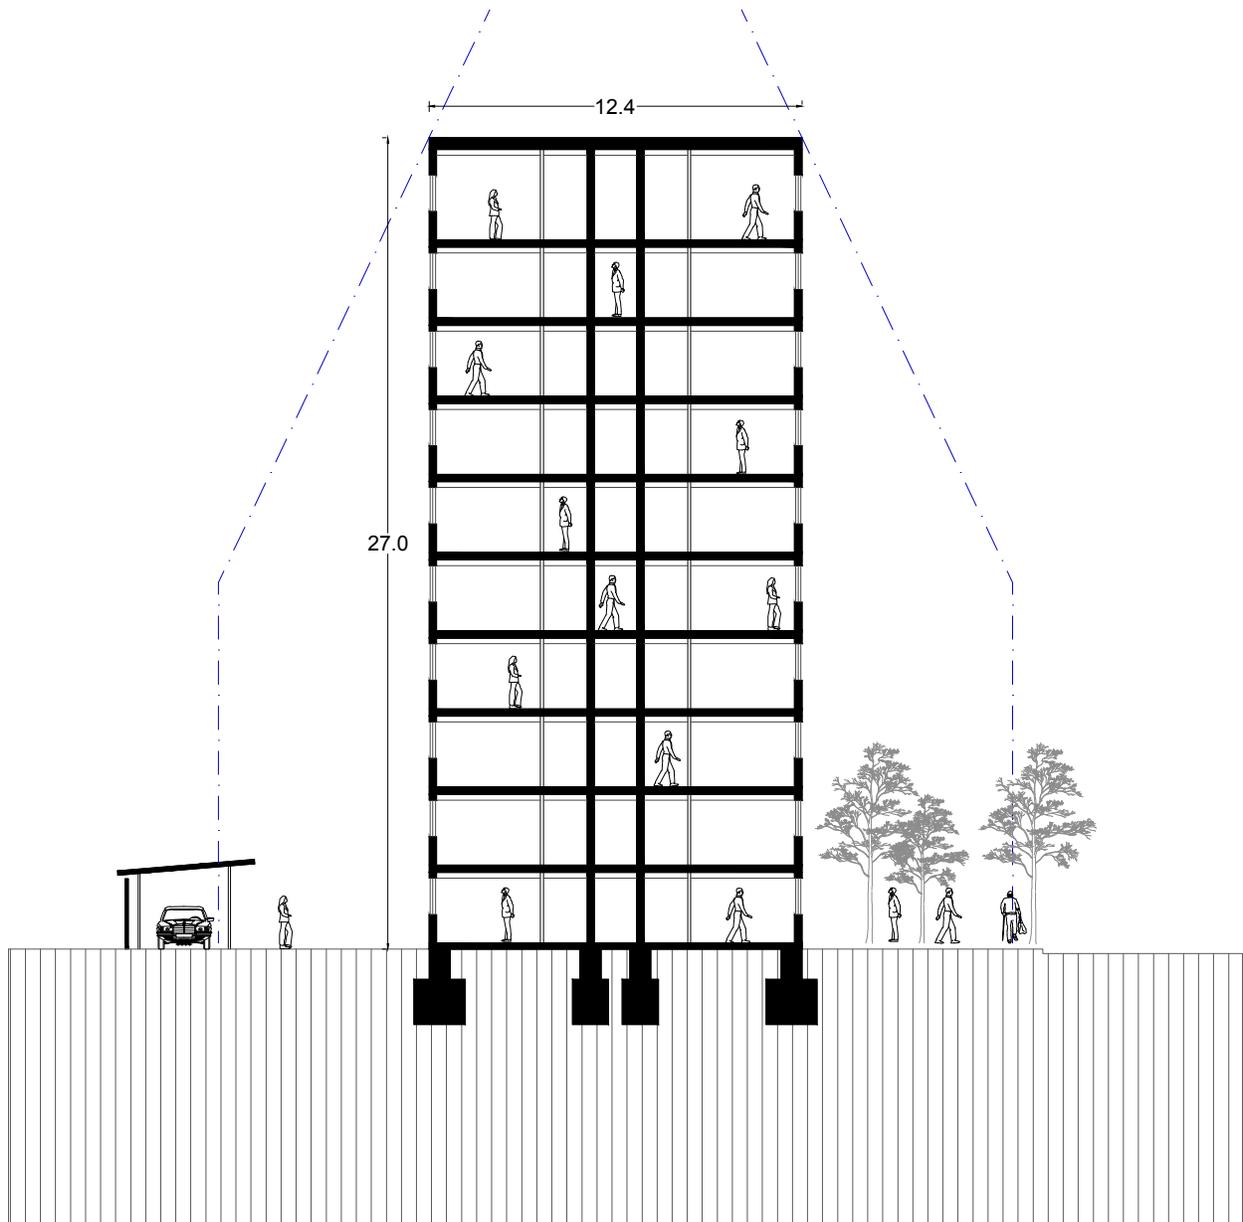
Corte Transversal. Fuente: Elaboración Propia.
